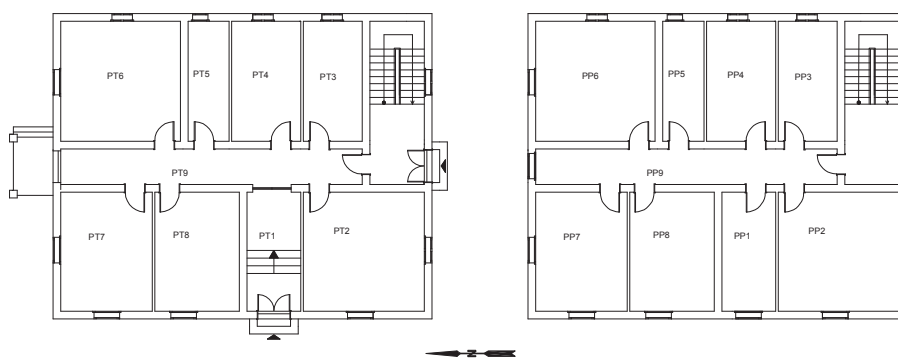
Caso di studio – Pianta del piano terra e del primo piano.
